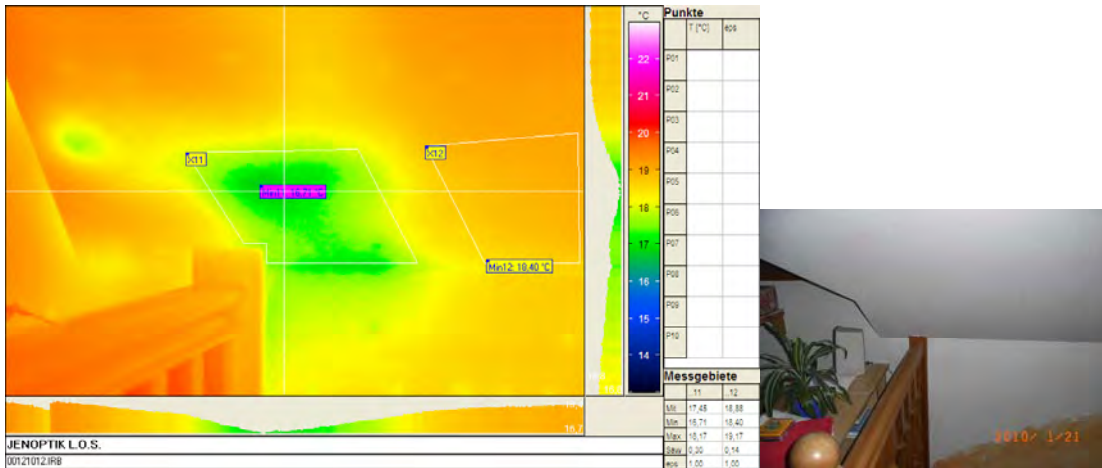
BV SIR, 1988/1996: Großflächige Wärmebrücke im Bereich der Gefachdämmung des nachträglich ausgebauten Dachgeschoßes; Ursache ohne Öffnen der Konstruktion nicht eindeutig bestimmbar.
